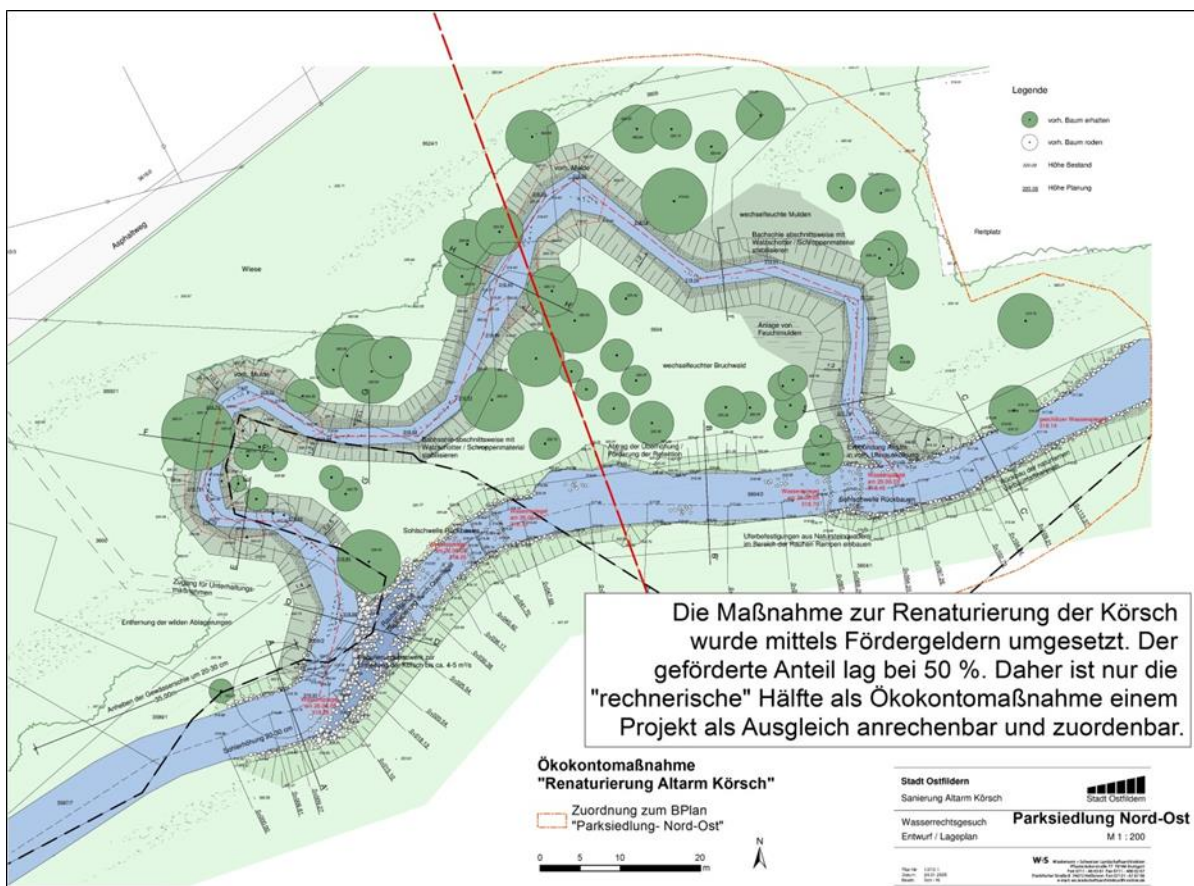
Entwurfsplan zur Sanierung Altarm Körsch. Stadt Ostfildern. Jan. 2005
